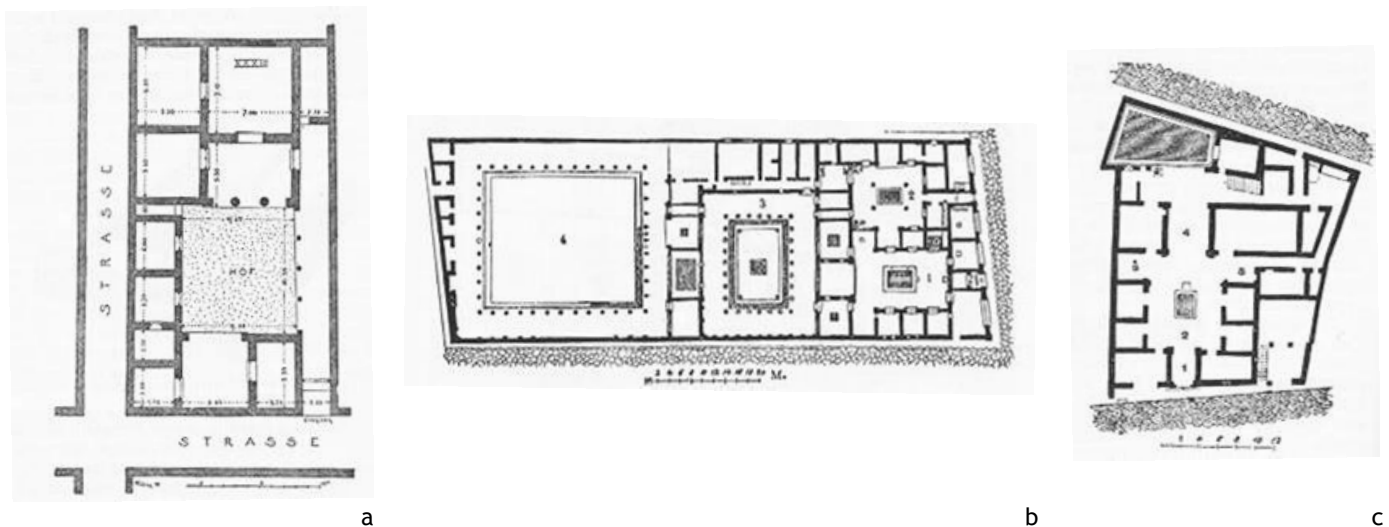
Exemplo de planta das casas de Priene - a; Exemplo de planta da “Casa do Fausno” - b; Exemplo de planta da “Casa do Cirurgião” - c.
